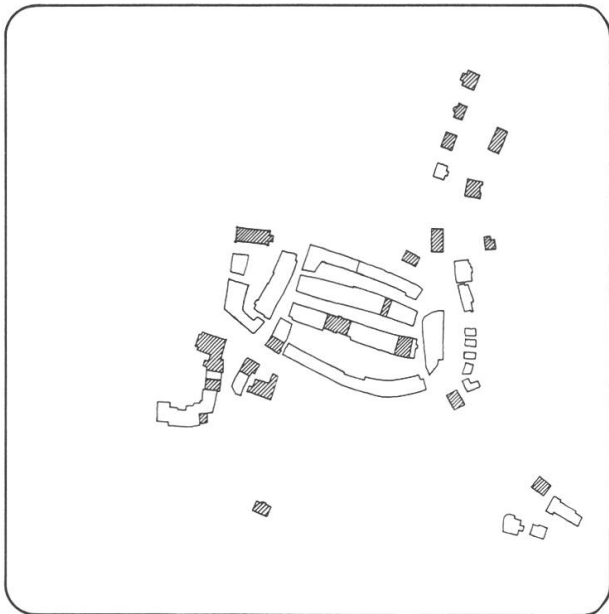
, Historisch herleitbare Bausubstanz als integrierende Bestandteile des städtebaulichen Grundmusters (unter Denkmalschutz stehende Bauten sind schraffiert)
